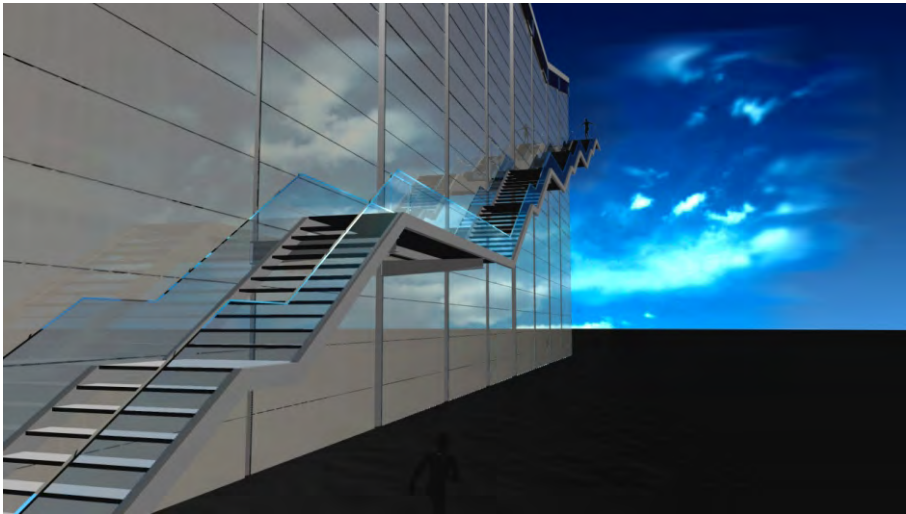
/ ACERCAMIENTO A LA FACHADA OESTE, DONDE SE ENCUENTRA LA ESCALERA DE EMERGENCIA.
